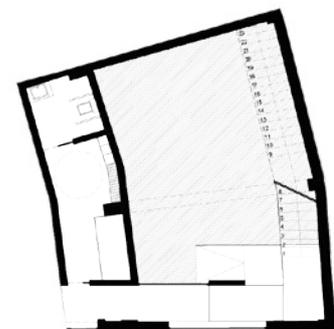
Planta Piso 0 | Piscina Termal | Bloco A
